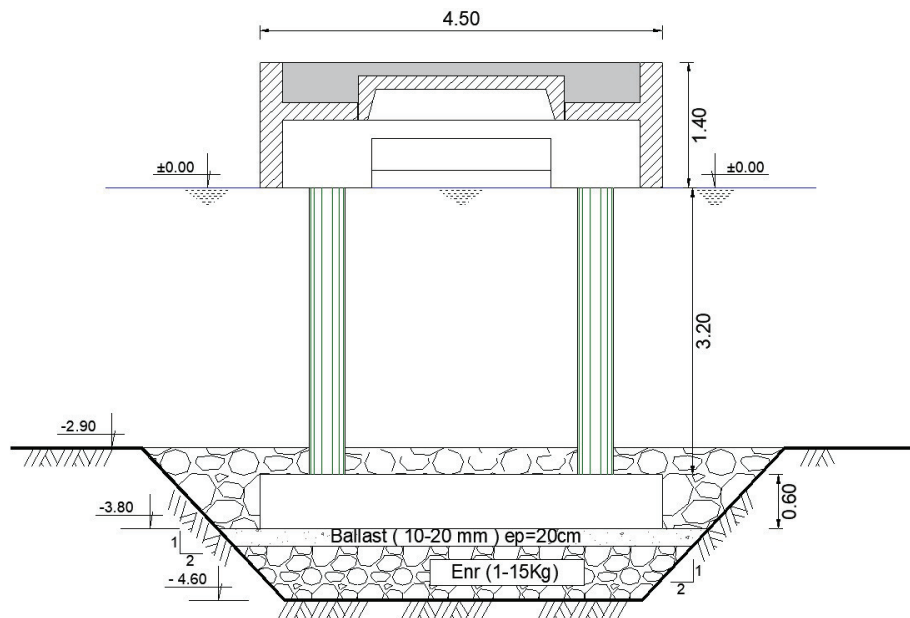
Coupe transversale de l'appontement à -2.90m
